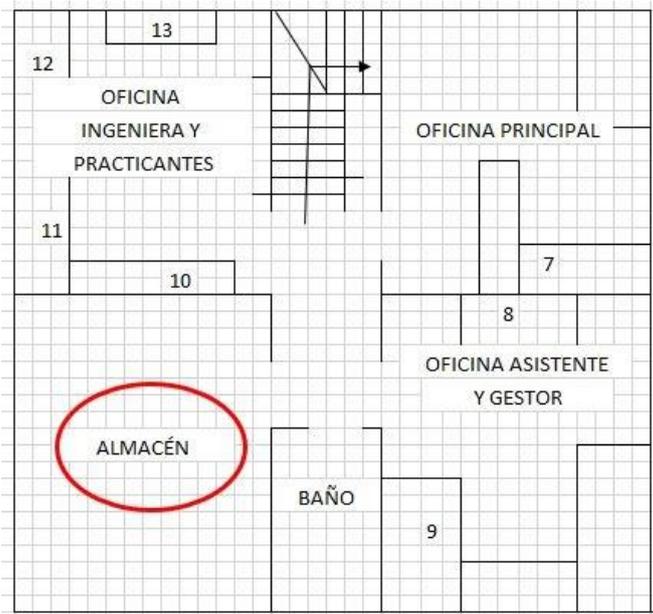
Plano de la segunda planta del área de ingeniería biomédica.
